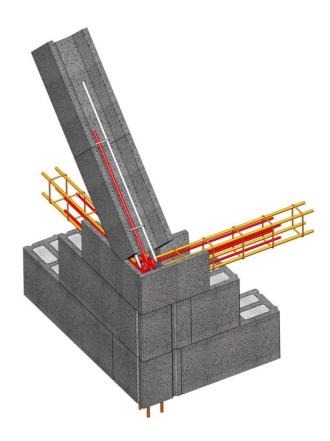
Jonction par juxtaposition d'un mur de refend/mur de façade non contreventant en zone non sismique
